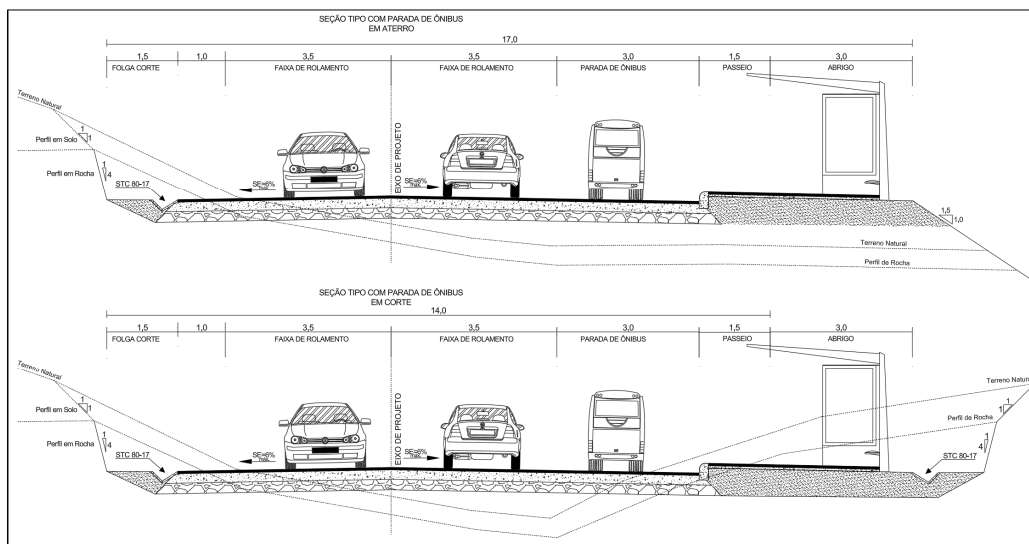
Elementos da Seção Transversal-Tipo de Terraplenagem – Dispositivo de Contenção
